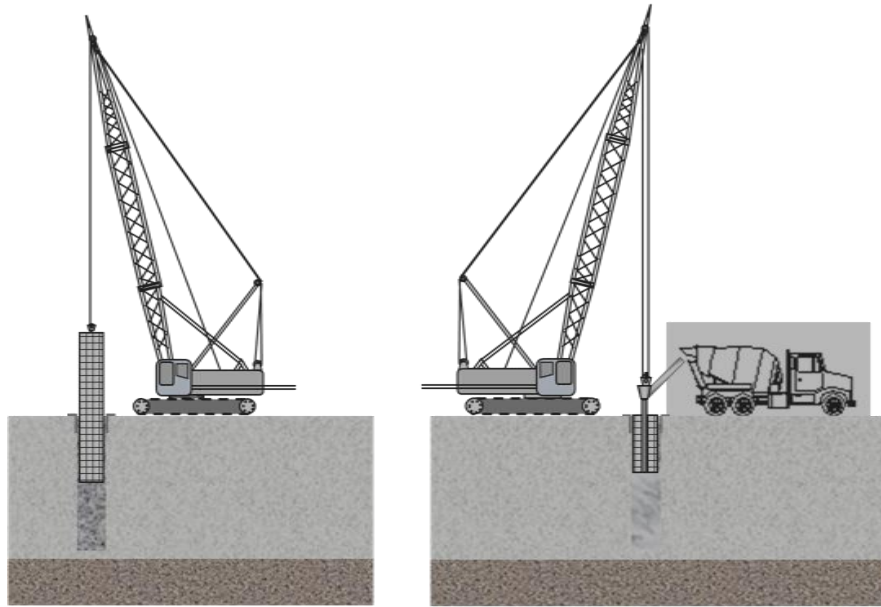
; Colocación de acero y colado del muro Milán.
